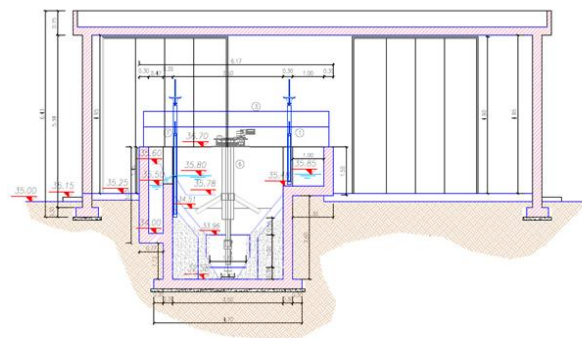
Pianta- nuovo edificio pretrattamenti Figura 11 _Sezione- nuovo edificio pretrattamenti
